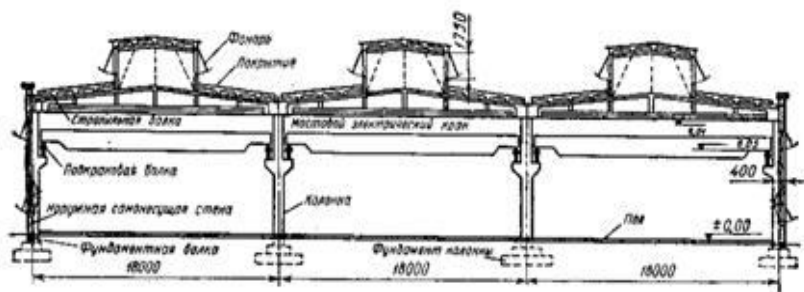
Одноэтажное трехпролетное промышленное здание со световыми фонарями.
